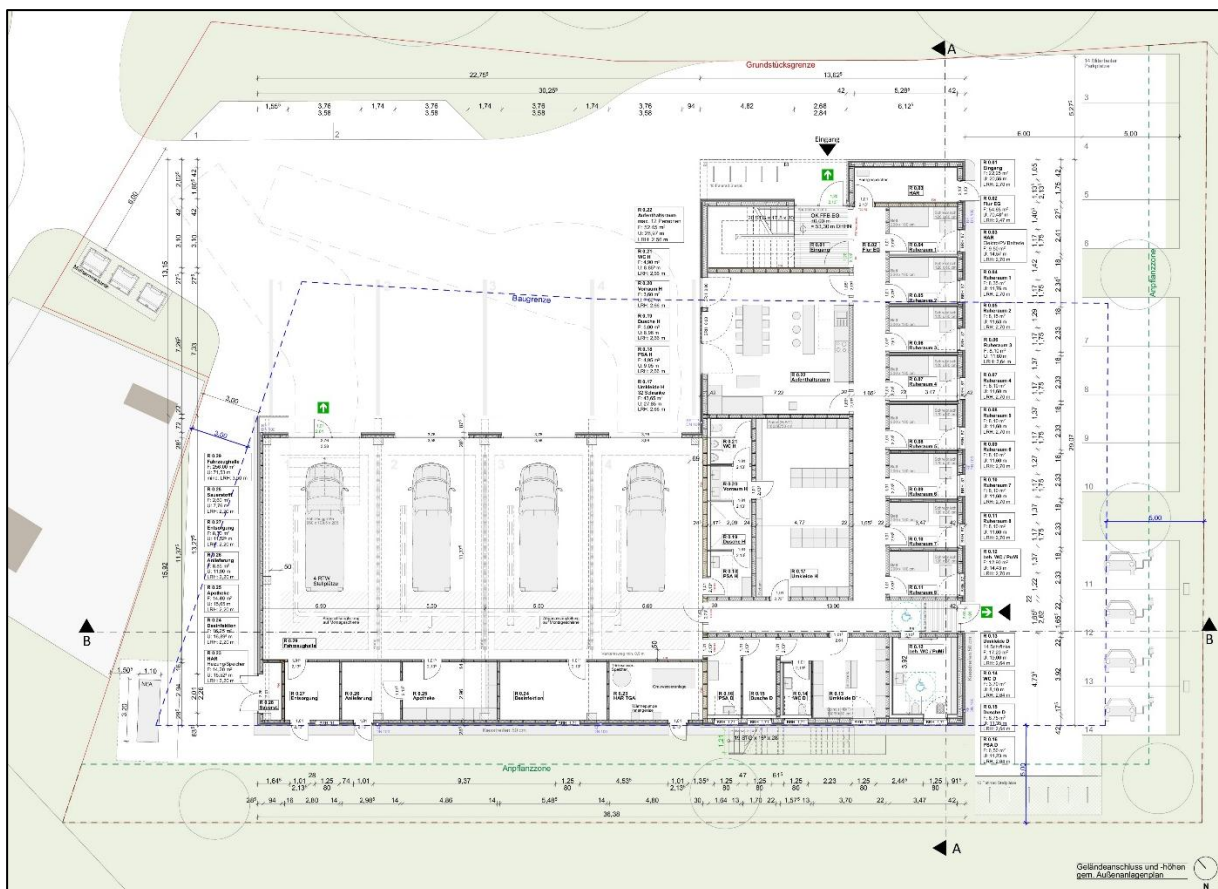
Genehmigungsplanung Neubau Rettungswache Schönfließ vom 26.10.2025 - Erdgeschoss. BKMA Bruch Kunath Müller Architekten, 16547 Birkenwerder
